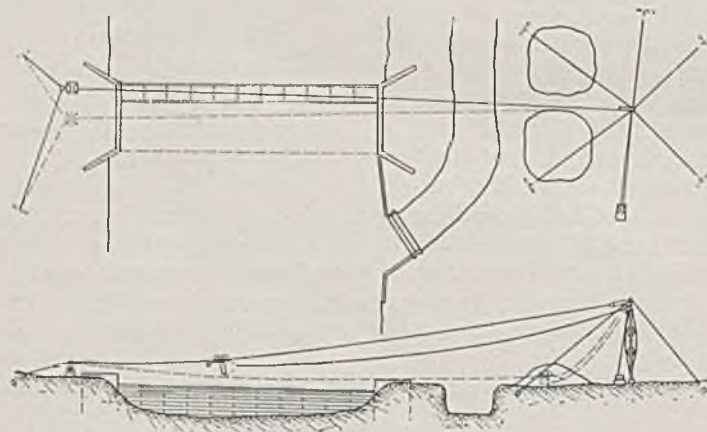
Kabelbagger zum Einbringen von Beton beim Bau eines Stauwehres.
